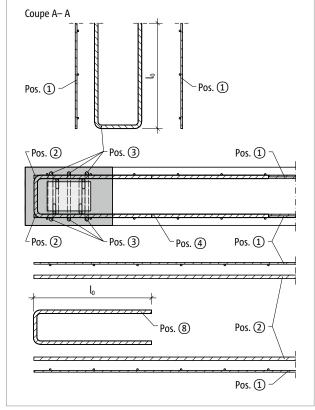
Schöck Sconnex® type W-N-VH : variante A – renforcement sur site avec Pos. 4 pour le raccordement en l'extrémité du mur
